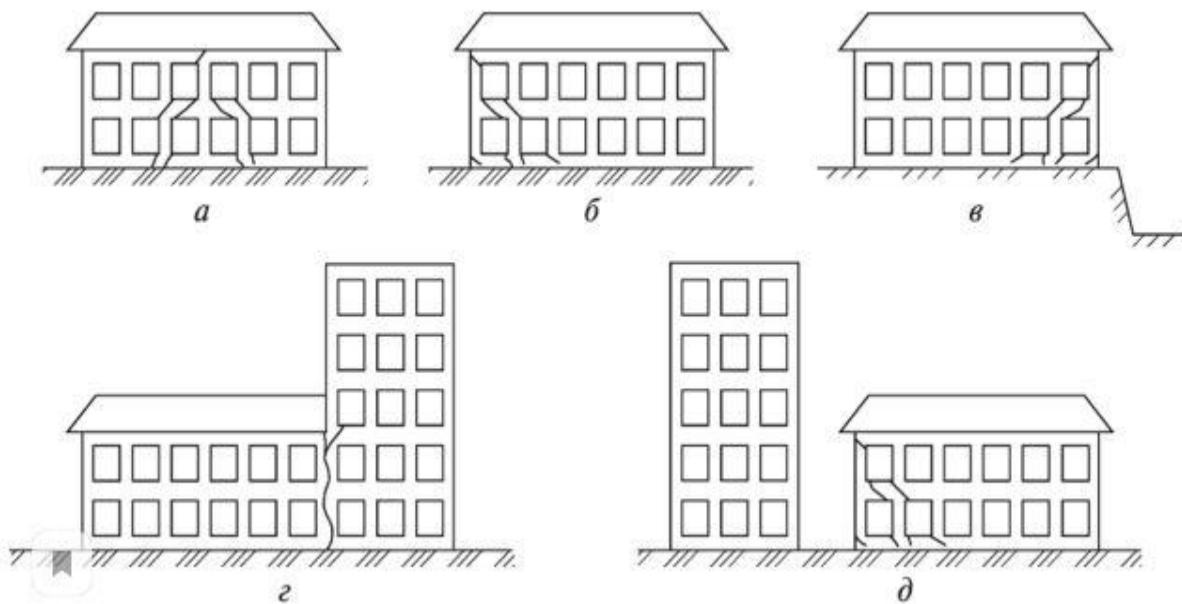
Причины образования трещин в несущих стенах из-за неудовлетворительного состояния оснований и фундаментов: а — слабые грунты под средней частью здания; б — то же у
